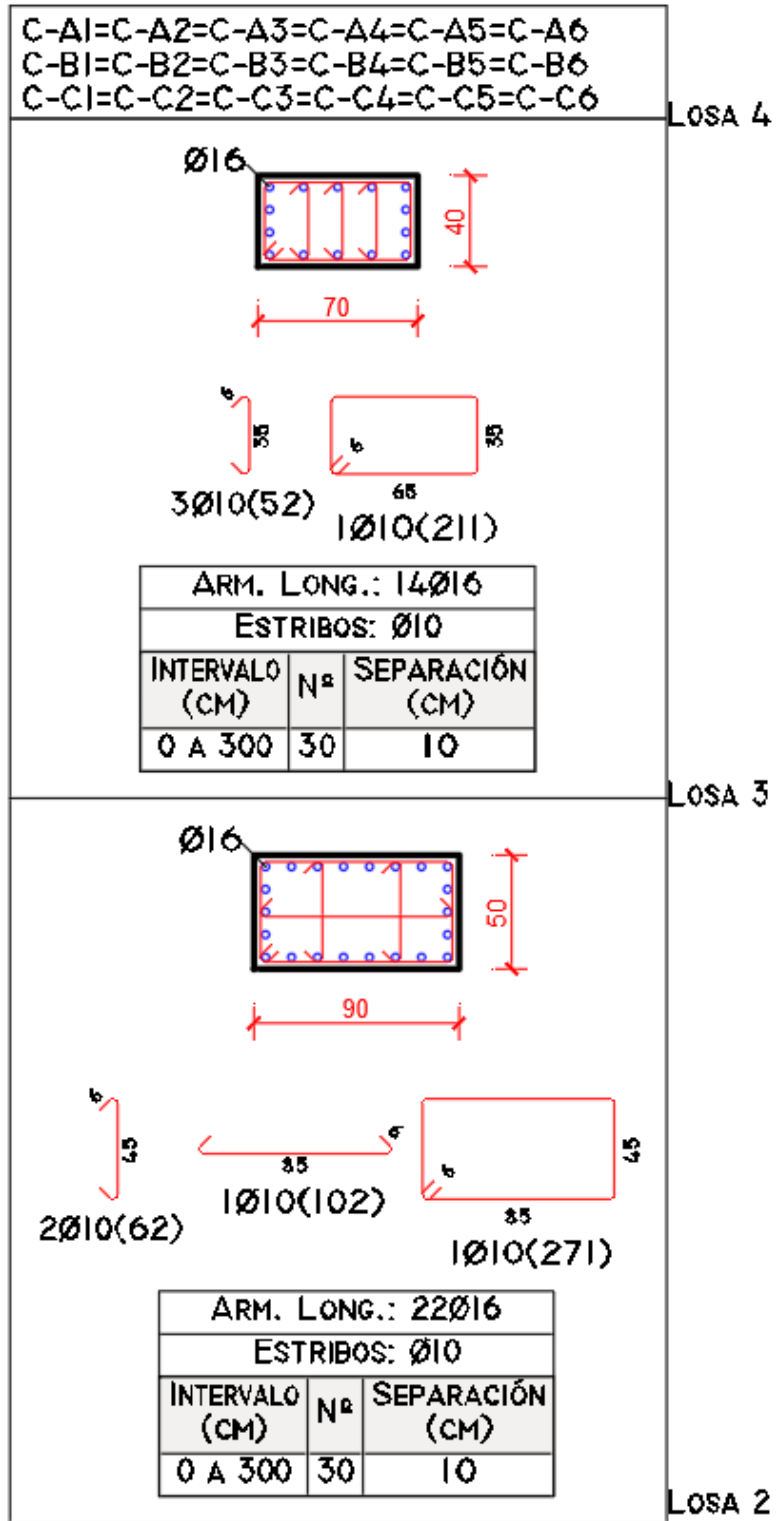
Detalle de Refuerzo Columnas, de Losa 2 a Losa 4, Estructura [7N-EE].
